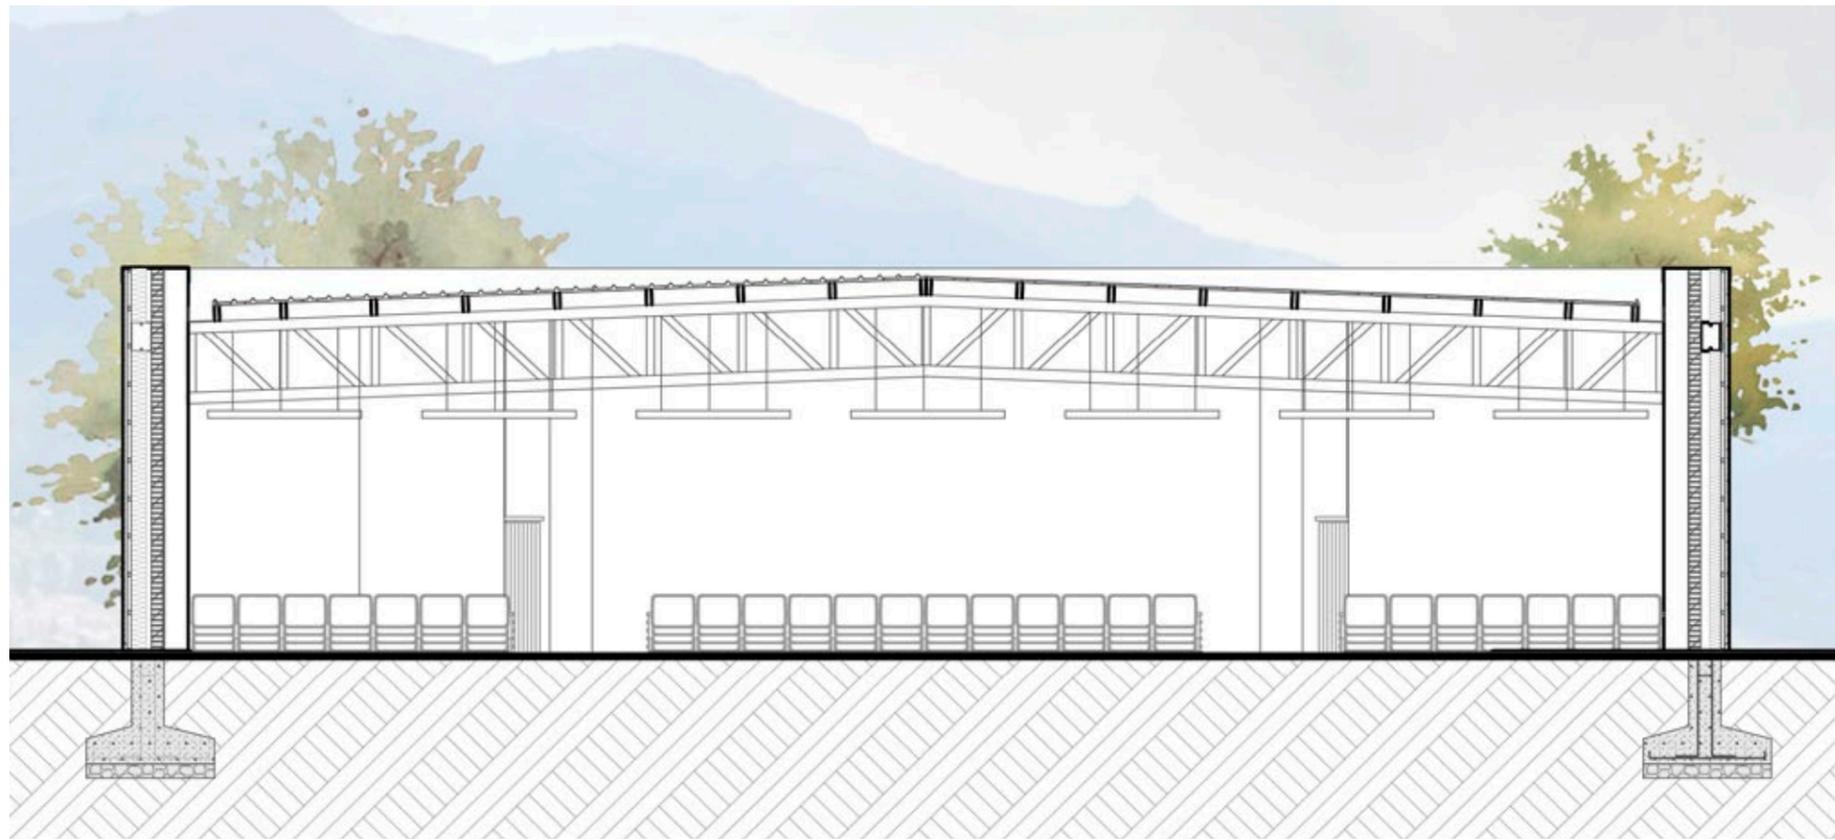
| Sección general del coliseo | Fuente: Elaboración Propia
